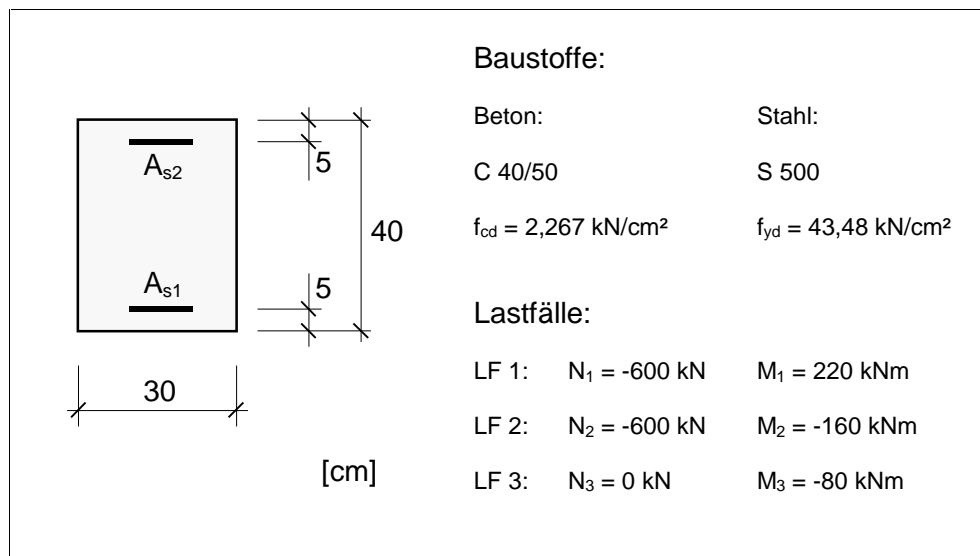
Stahlbetonquerschnitt unter verschiedenen Beanspruchungskombinationen
